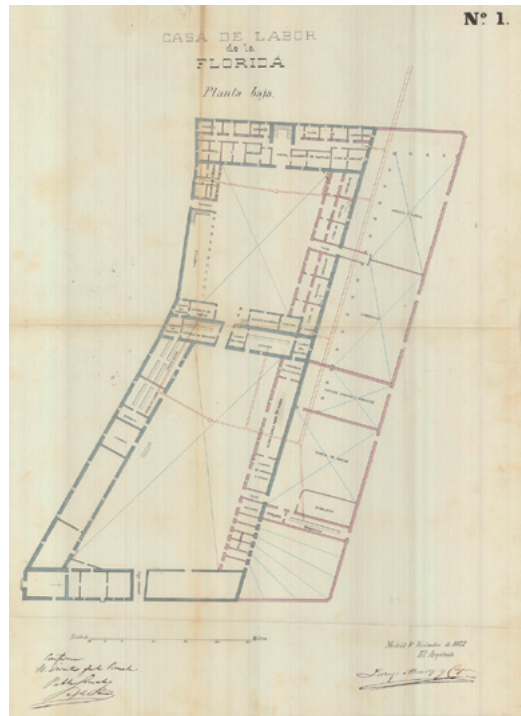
Casa de Labor de la Florida. Planta baja. Lorenzo Álvarez y Capra, 1877. Fuente: AGA, Fondo Ministerio de Educación, IDD (05)001.025, Caja 31/08132.
